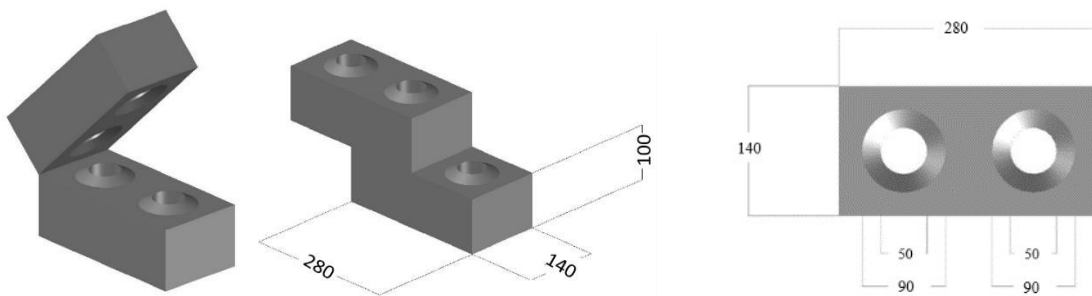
Dimensões do bloco utilizado em mm: a) vista em perspetiva; b) visualização de encaixes; (c) vista superior.
